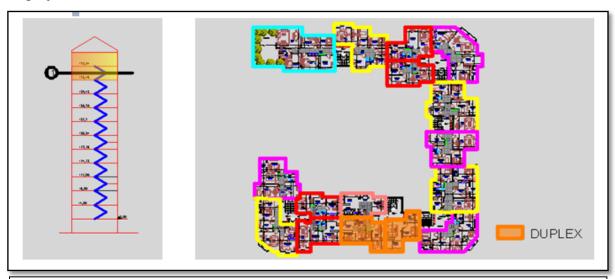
(III.7): Schéma type d'assemblage du duplex niveau 10à 12 Source: auteures 2016.
